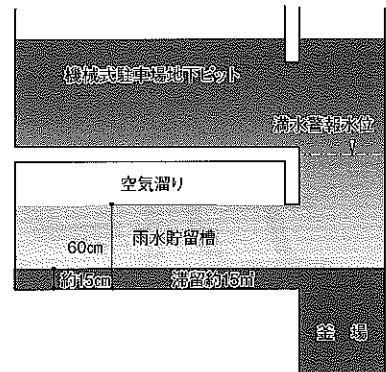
機械式駐車場地下ピットとその下の雨水貯留槽の断面図
